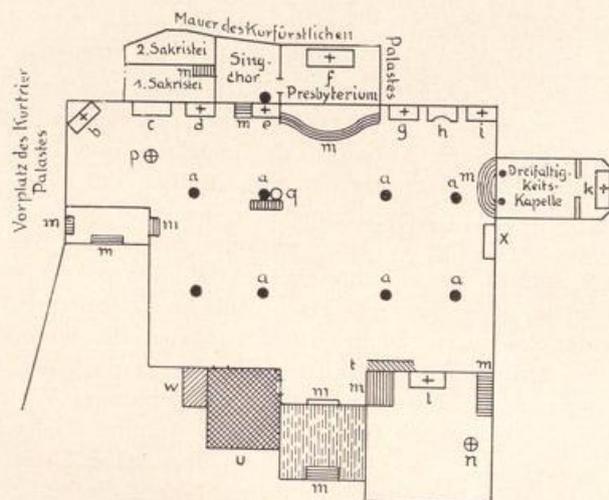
Ehem. Laurentiuskirche. Grundriß nach Müller.
